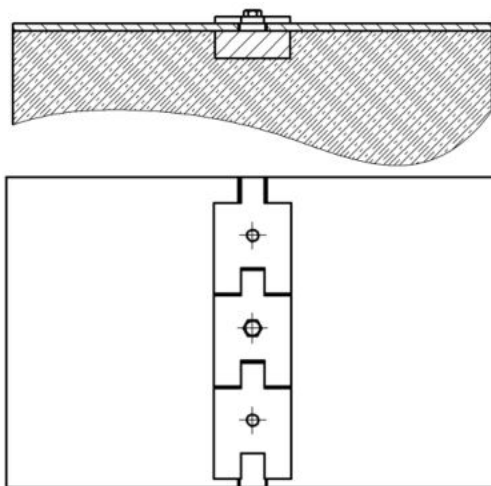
Шарнирная схема закрепления листов металлооблицовки
